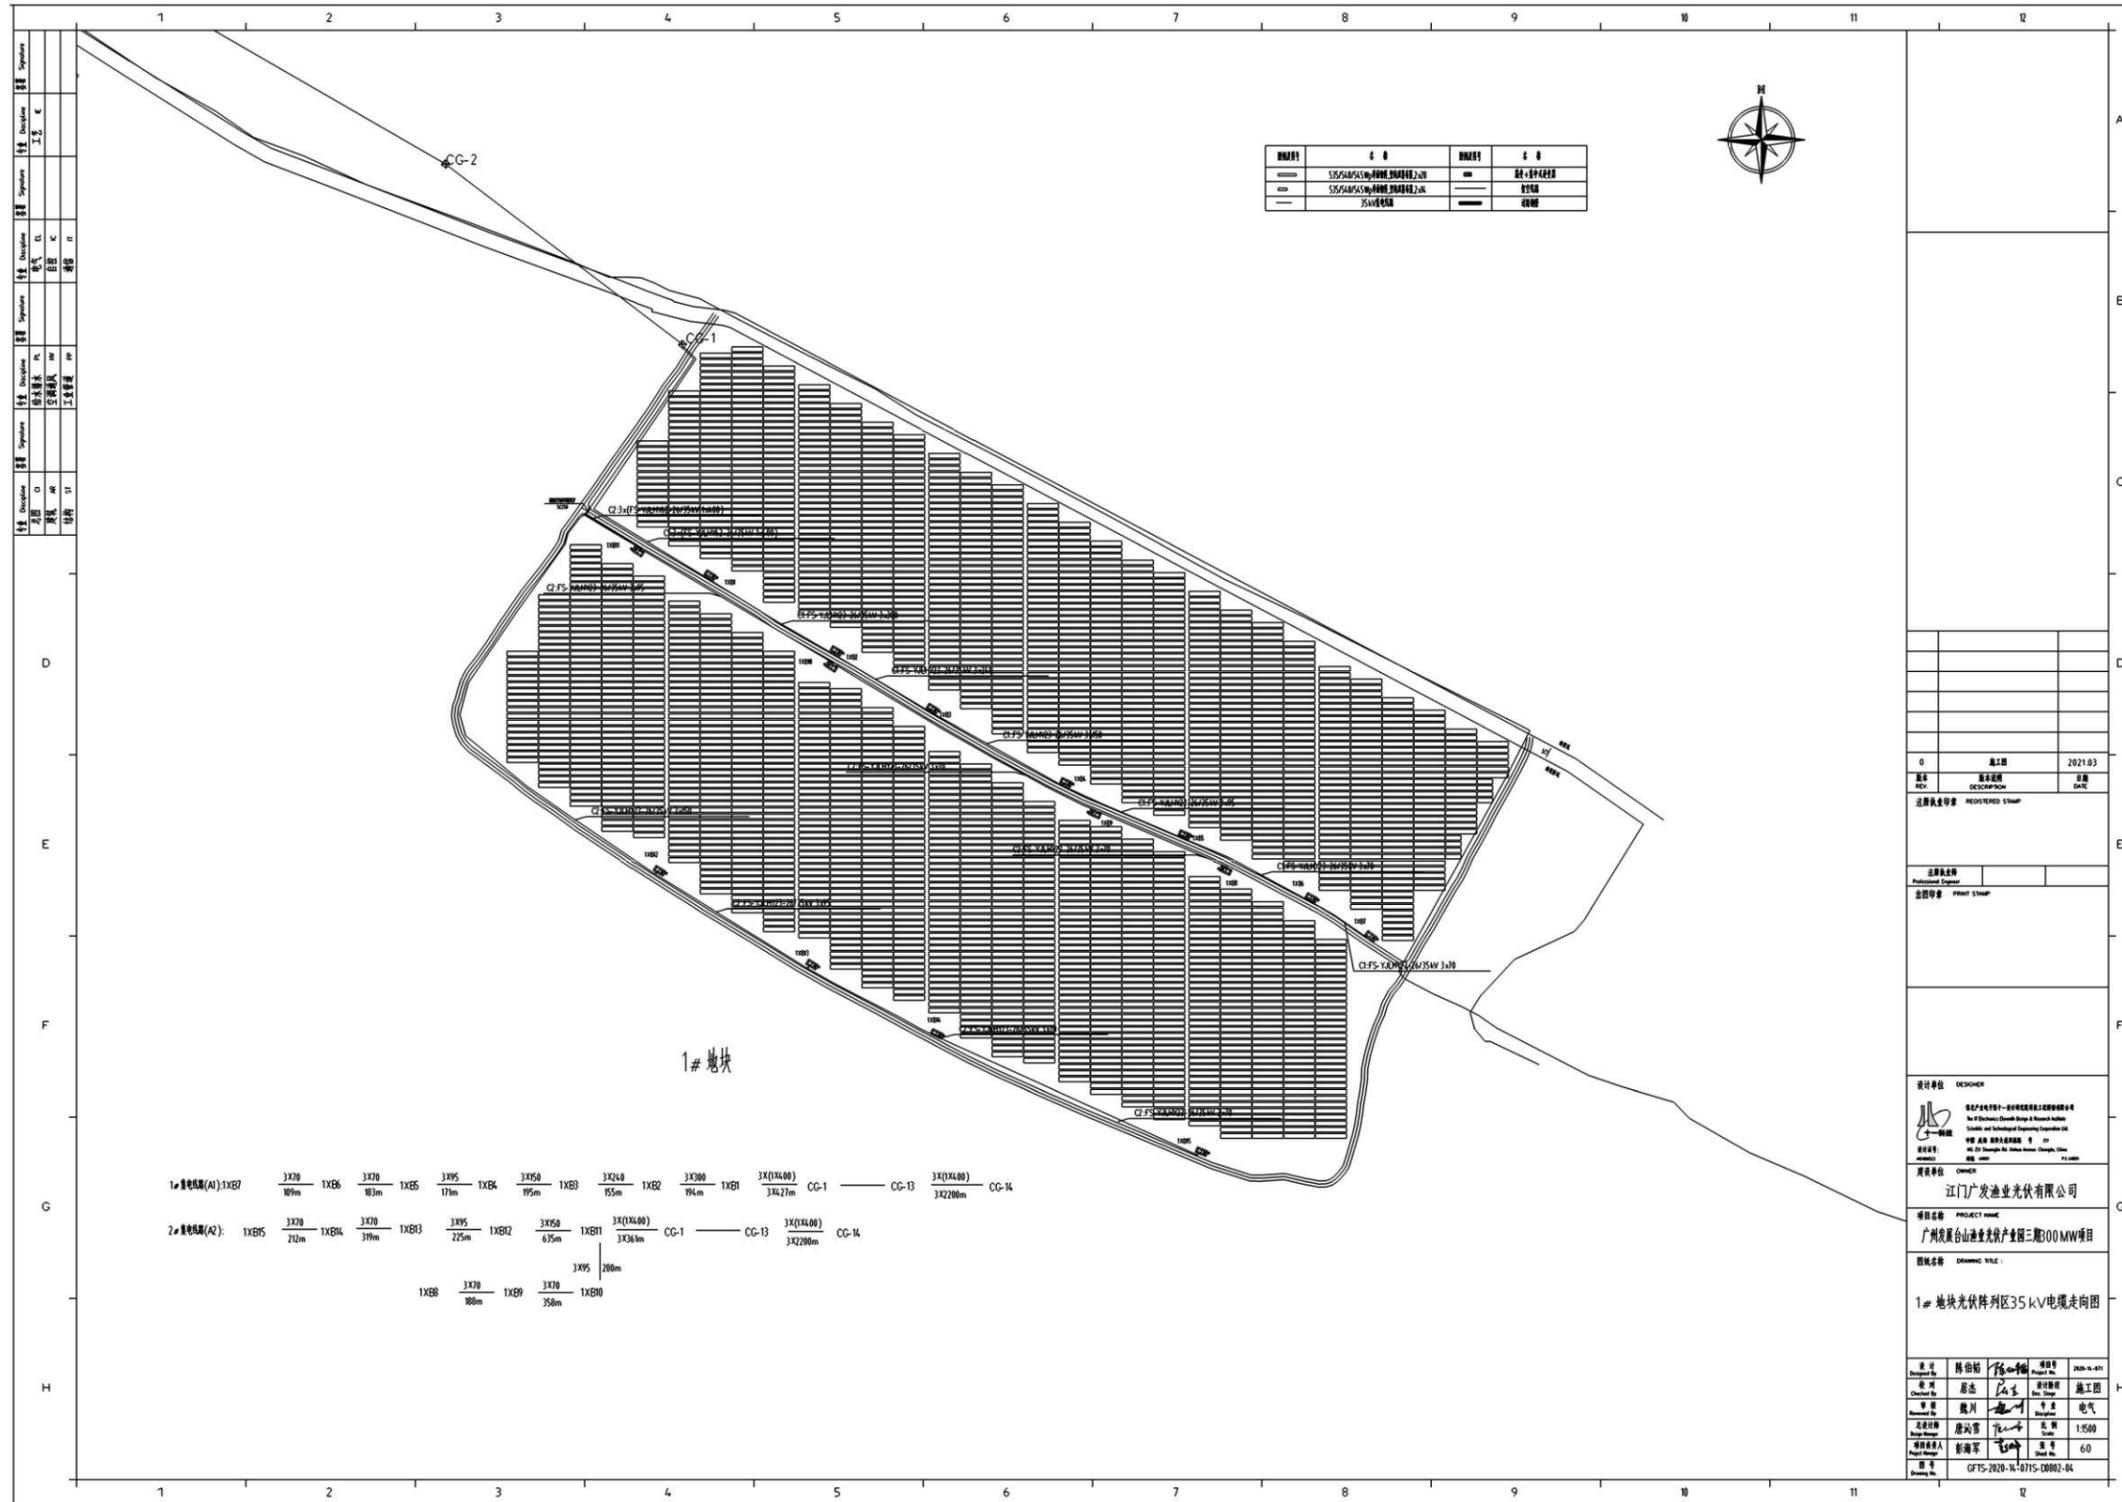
光伏区平面布置图 (A13-A14)
